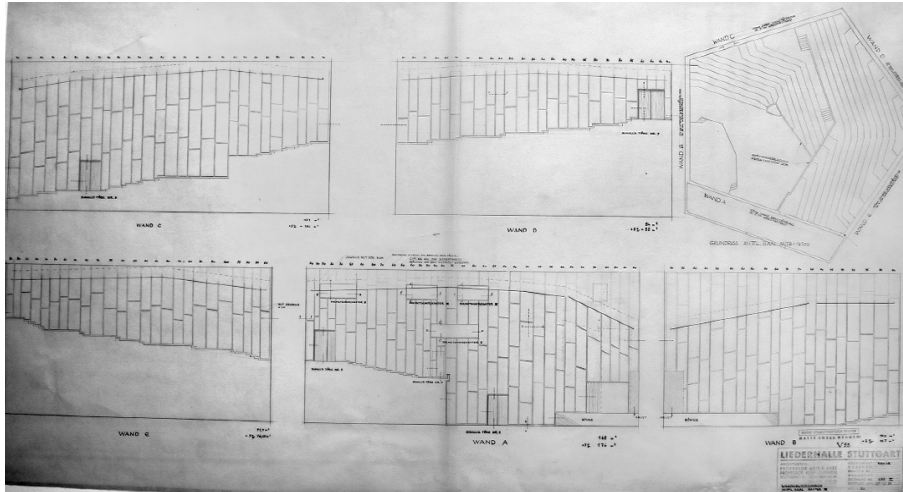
Grundriss- und Wandabwicklung, Mozartsaal, Büro Gutbrod, 1956.
